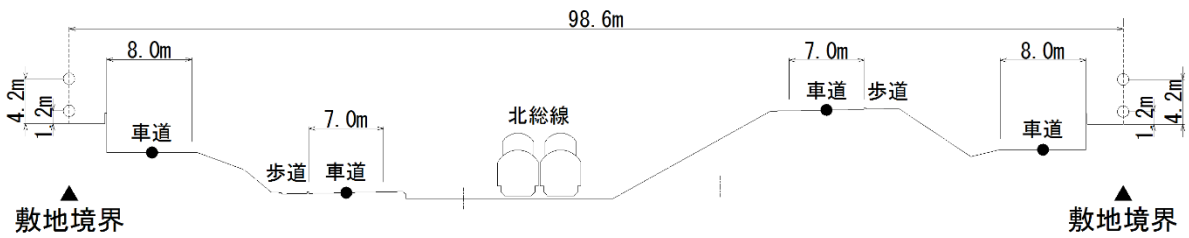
(8) 予測断面図 (H. 一般国道464号(5))
